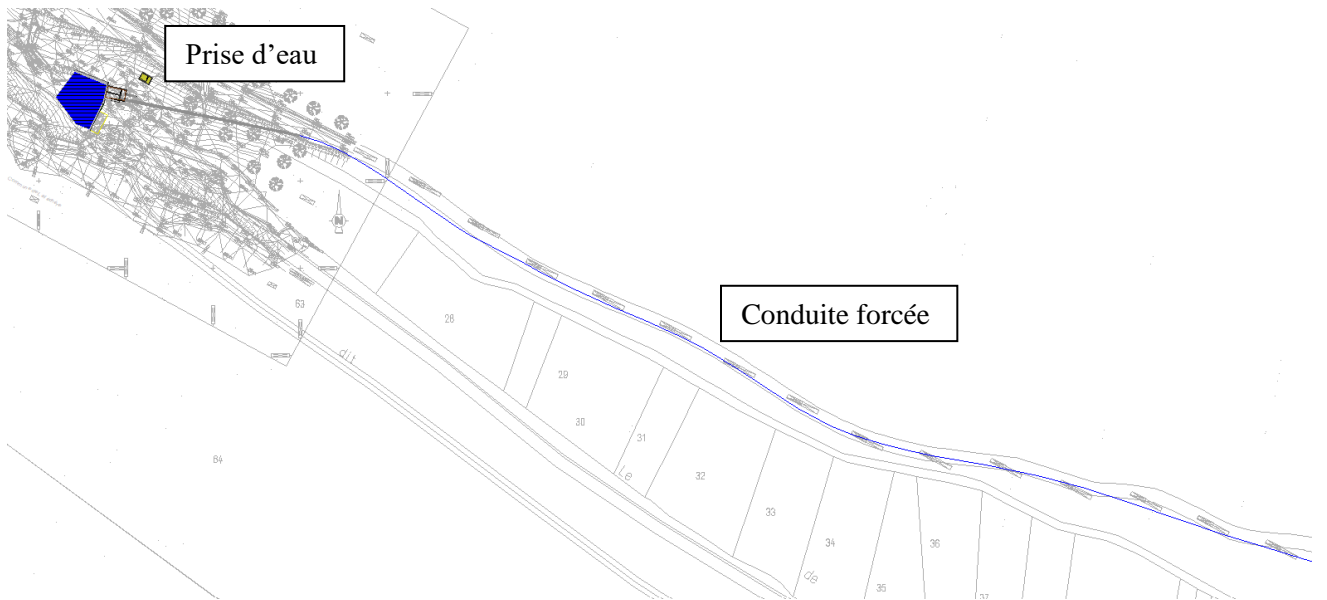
Implantation conduite forcée sur fond cadastral (1)
